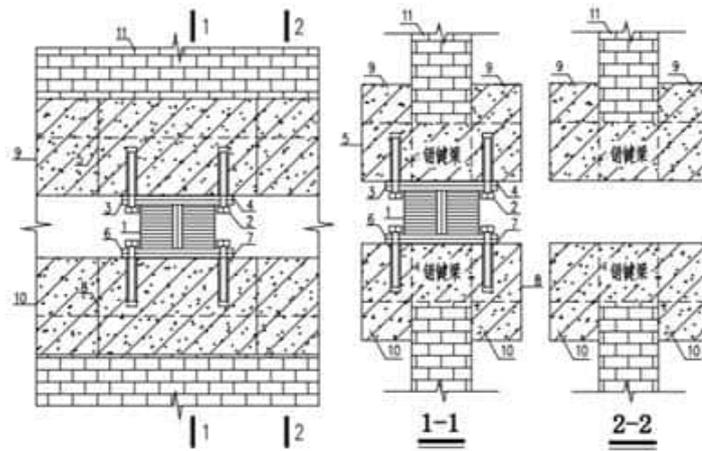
双夹梁墙体托换及隔震支座安装示意图
